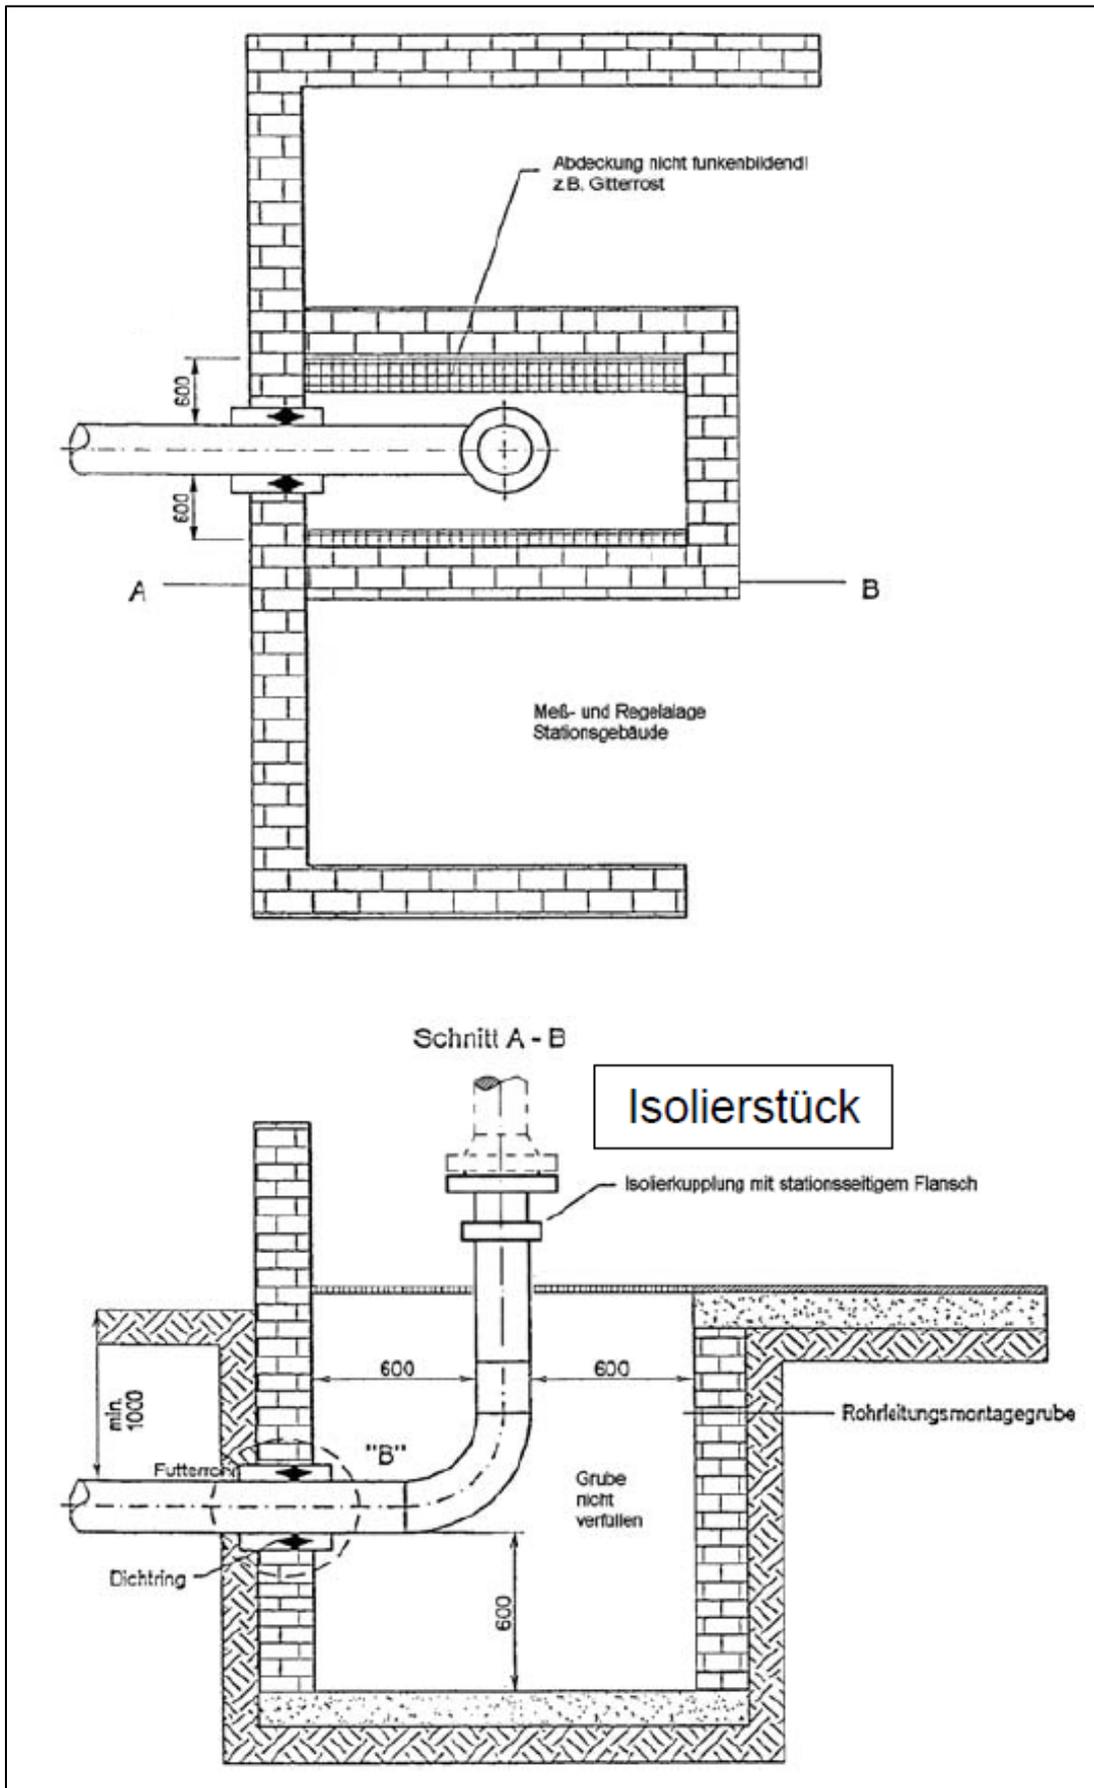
Leitungseinführung in GDRM-Anlagen mit Schacht; Anordnung und Lage des Isolierstücks, Verschluss der Wanddurchführungen
